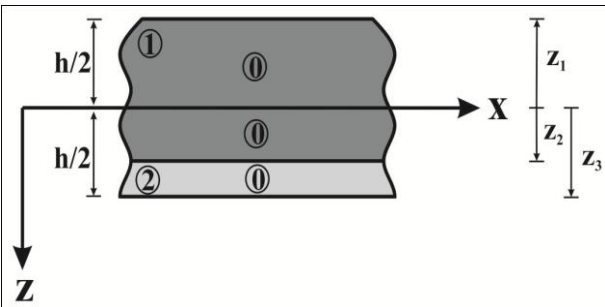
Durum 1'e ait betonarme döşeme plağı
